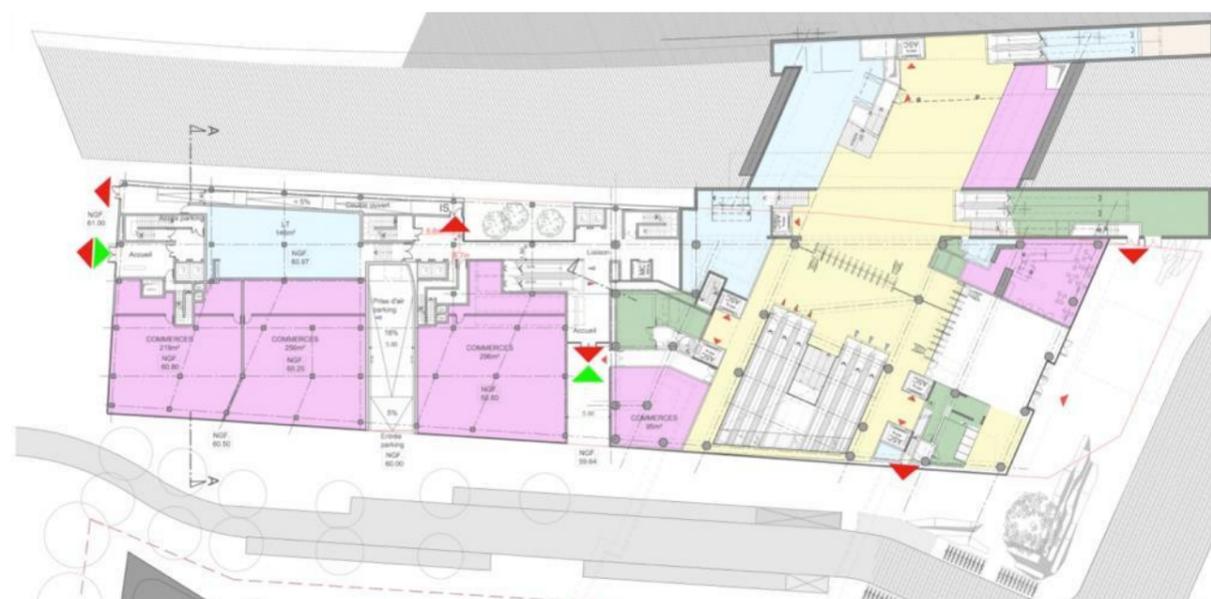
Gare d'Arcueil Cachan – plan masse avec projet connexe
